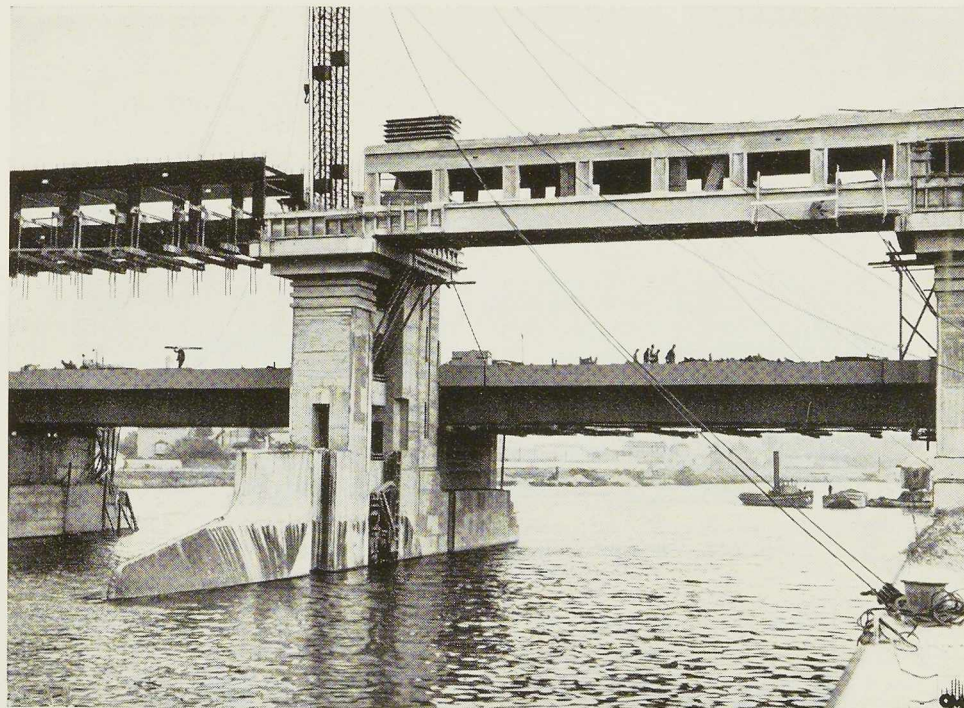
Vue amont du barrage d'Ivoz-Ramet. On voit le pont-route situé en aval et la construction de la passerelle de service en poutres Vierendeel en acier enrobé.
